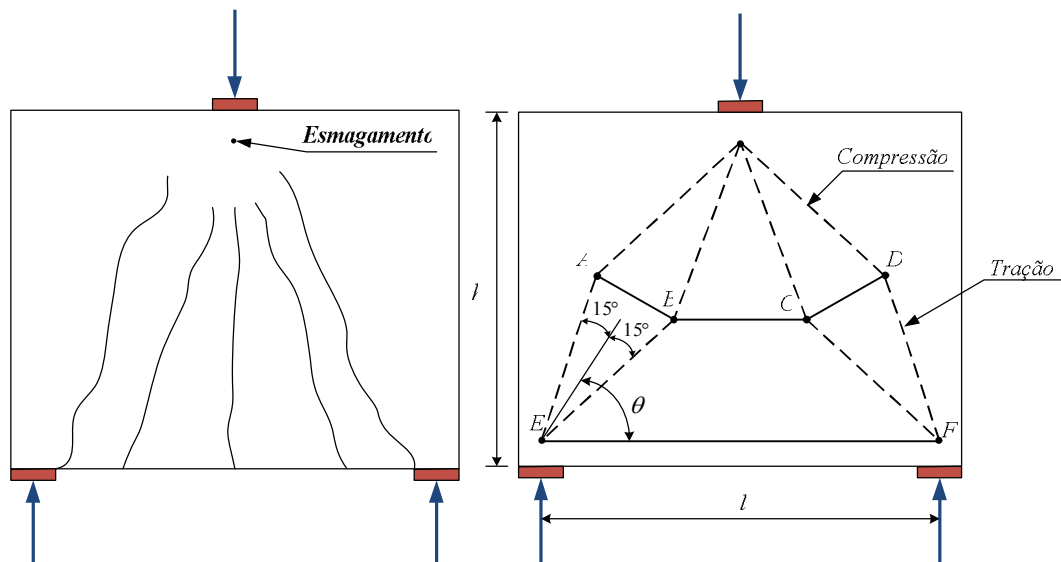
Modelo de bielas e tirantes via padrão de fissuração (Schlaich et al., 1987).
